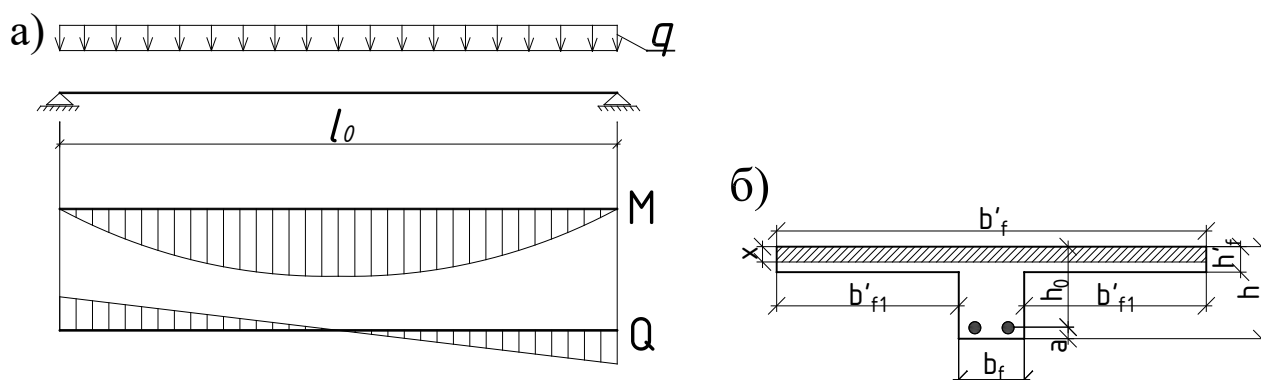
Расчетная схема продольных ребер (а) и их расчетное поперечное сечение (б)
